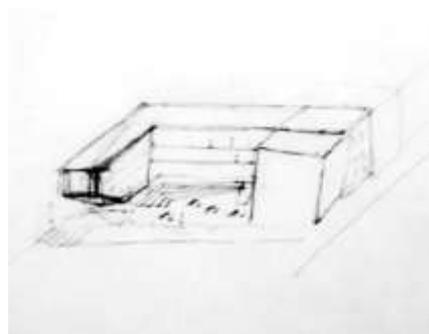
Esquisso – planta. (Ilustração nossa, 2013)
